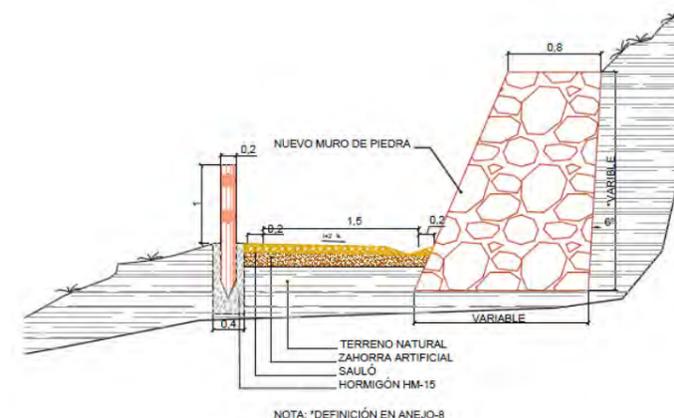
Sección de camino en ladera inclinada. Fuente: Proyecto constructivo.
